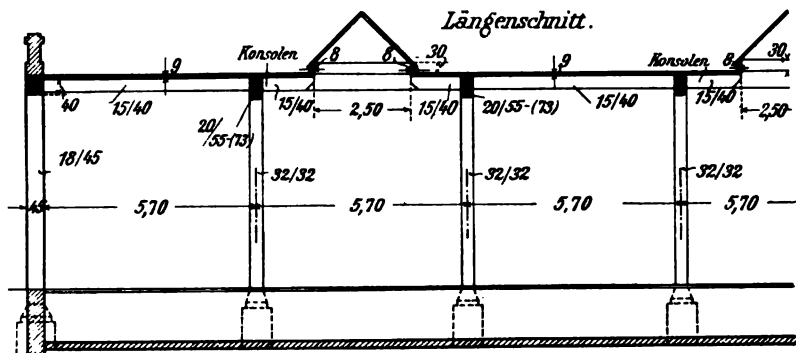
Längenschnitt A-B der Wagenhalle (zu Grundriß Abb. 108).
